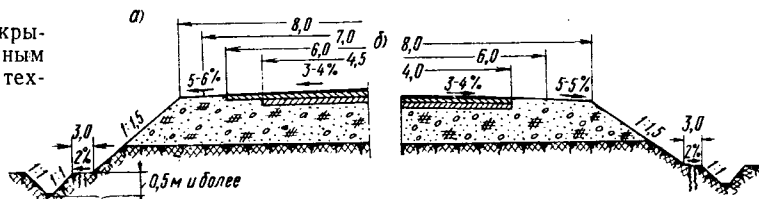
Поперечные профили земляного полотна и дорожной одежды из укрепленных грунтов на лесовозных дорогах Коми АССР
